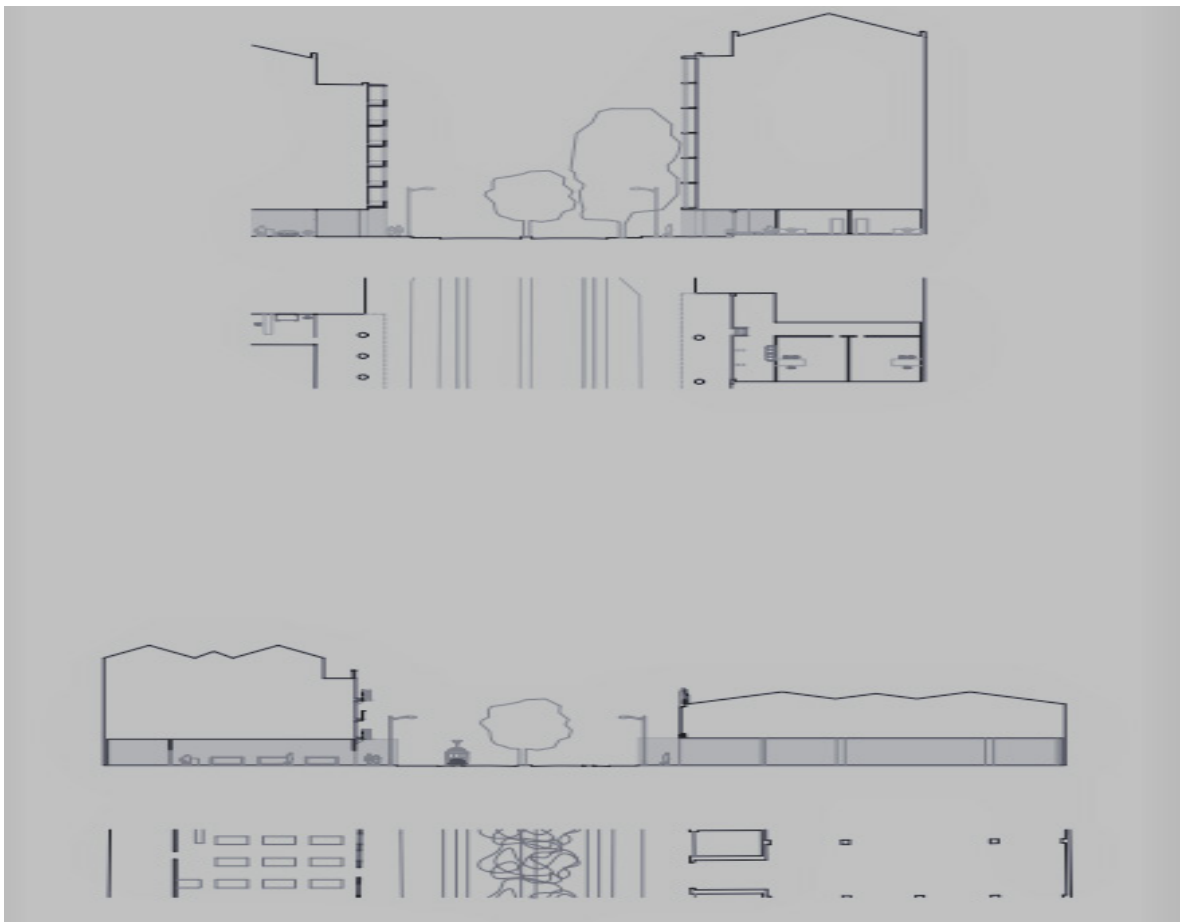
Seção transversal da Avenida Almirante Reis. Fonte: Do autor. 2022
